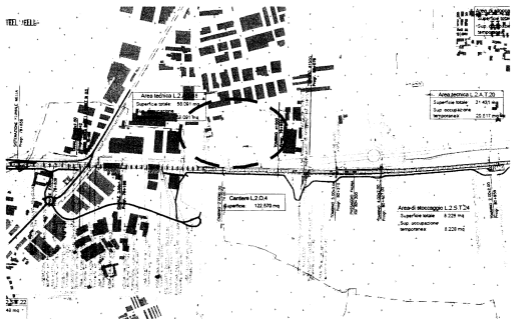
Estratto della tavola IN0500DE2P5CA00000190 con identificazione del cantiere L.2.D.4 con individuazione della collocazione alternativa
